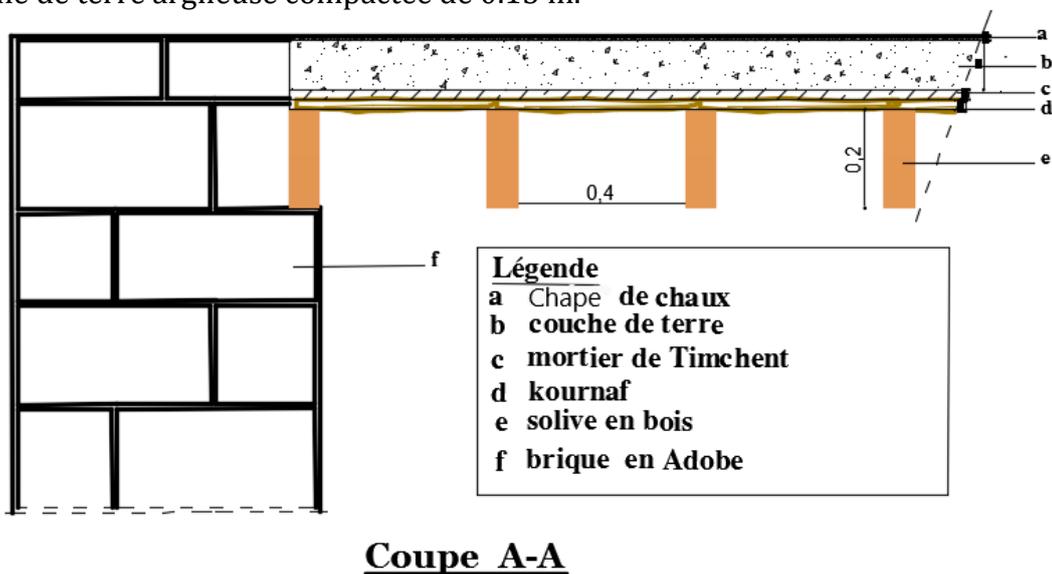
Détail constructif du plancher en madrier de bois. Source : les auteurs 2019.
